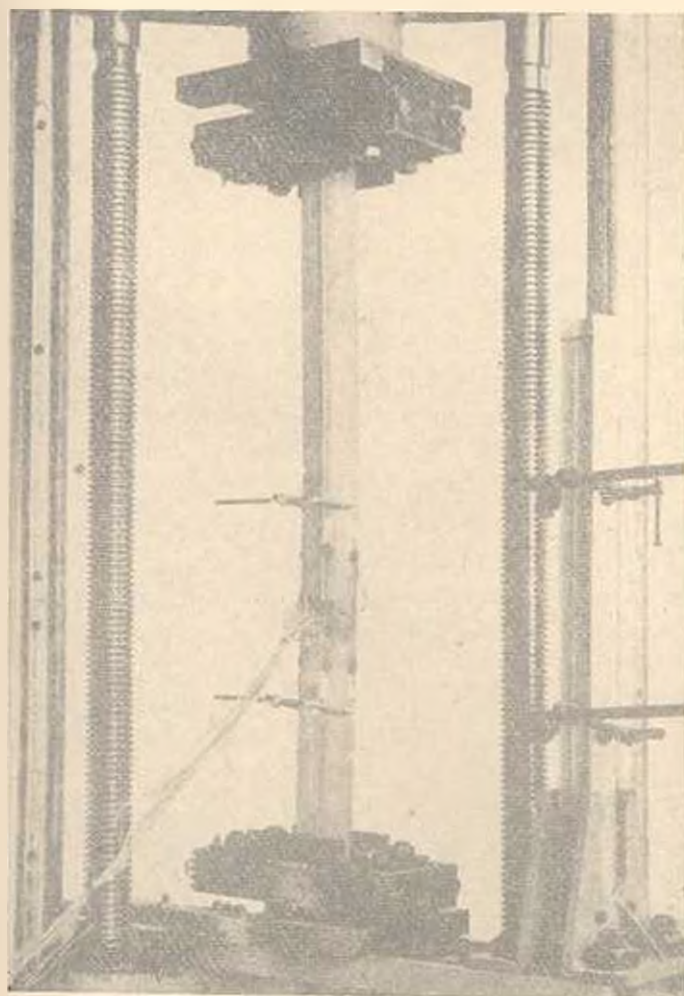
Испытание стержня прямоугольного сечения на внецентренное сжатие.
